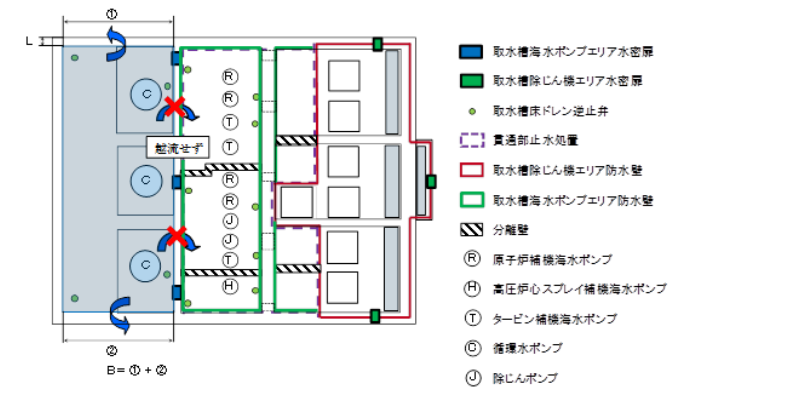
取水槽海水ポンプエリア平面図 (循環水系配管破損時)
